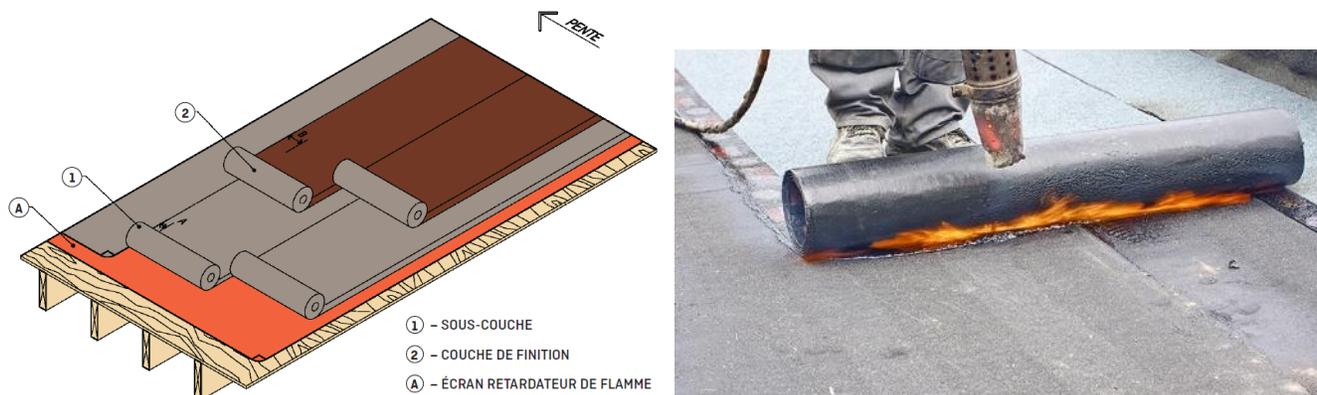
Structure et installation d'une toiture bicouche en élastomère
